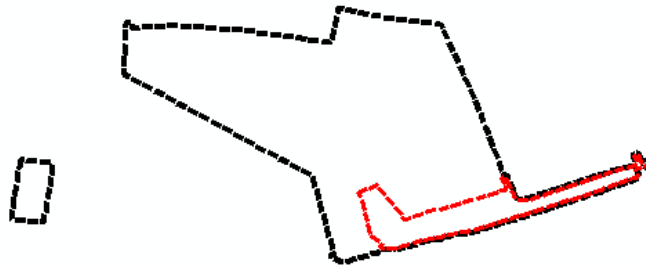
Geltungsbereich (schwarz) der 4. Änderung des Bebauungsplans und Teilbereich der Planung des Bundes (rot)
